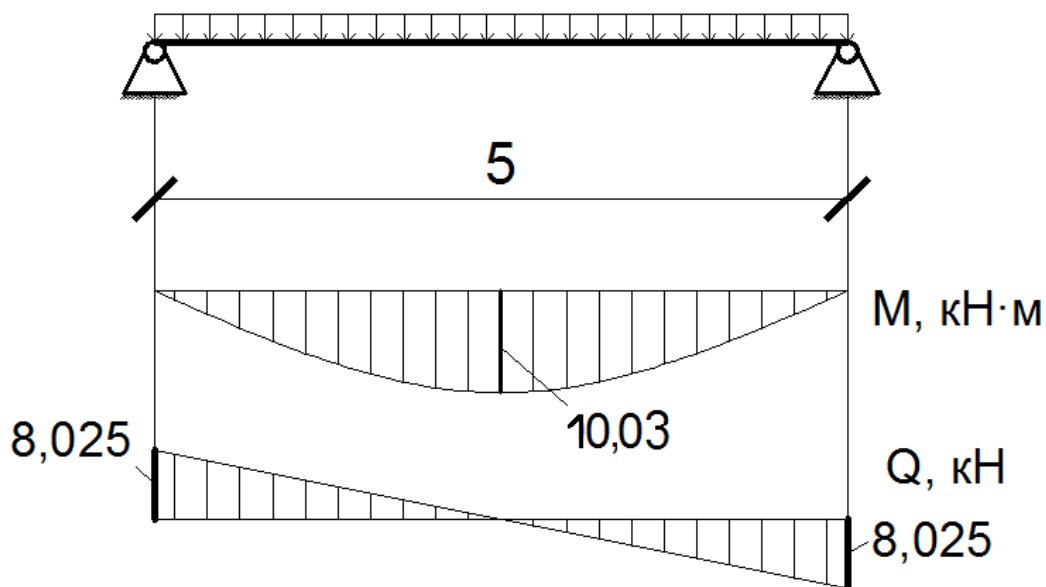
Расчетная схема плиты, эпюры изгибающего момента и поперечных сил
